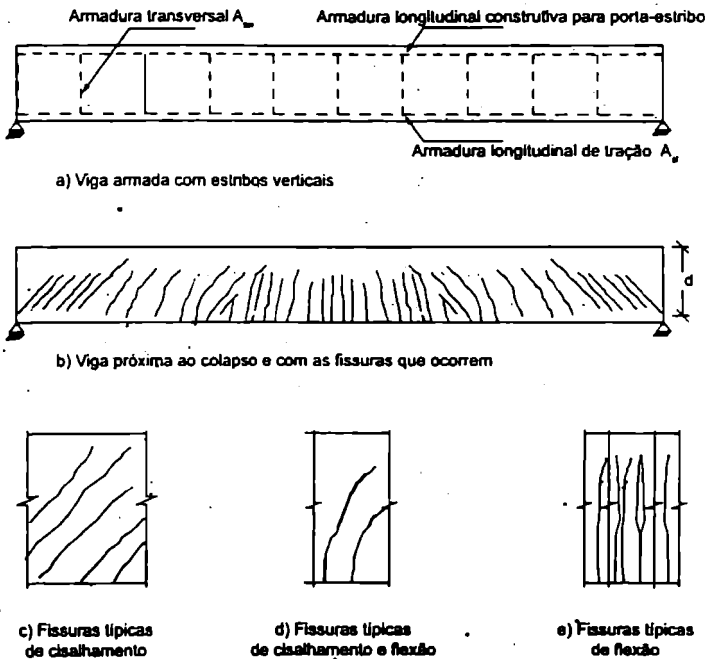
Viga na iminência da ruptura e os tipos de fissura que podem ocorrer.
